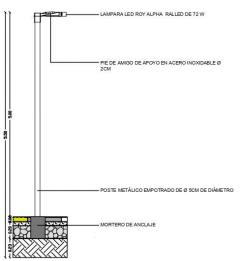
Detalle arquitectonico de luminaria tipo bolardo.
